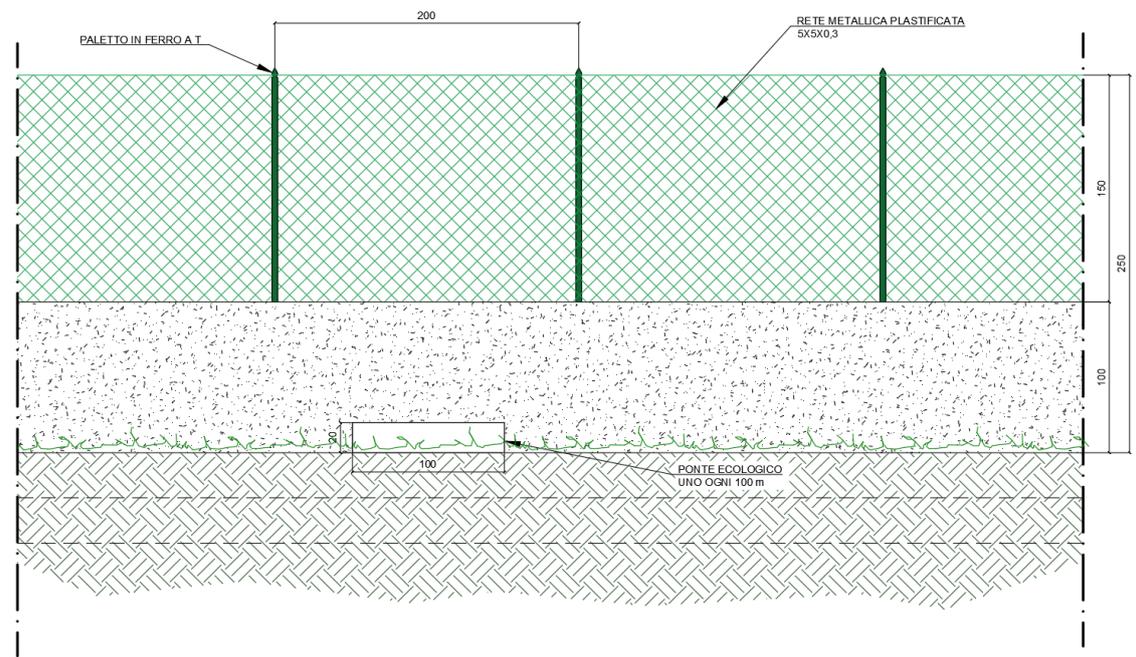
Recinzione realizzata con muro in calcestruzzo sormontato da rete metallica
